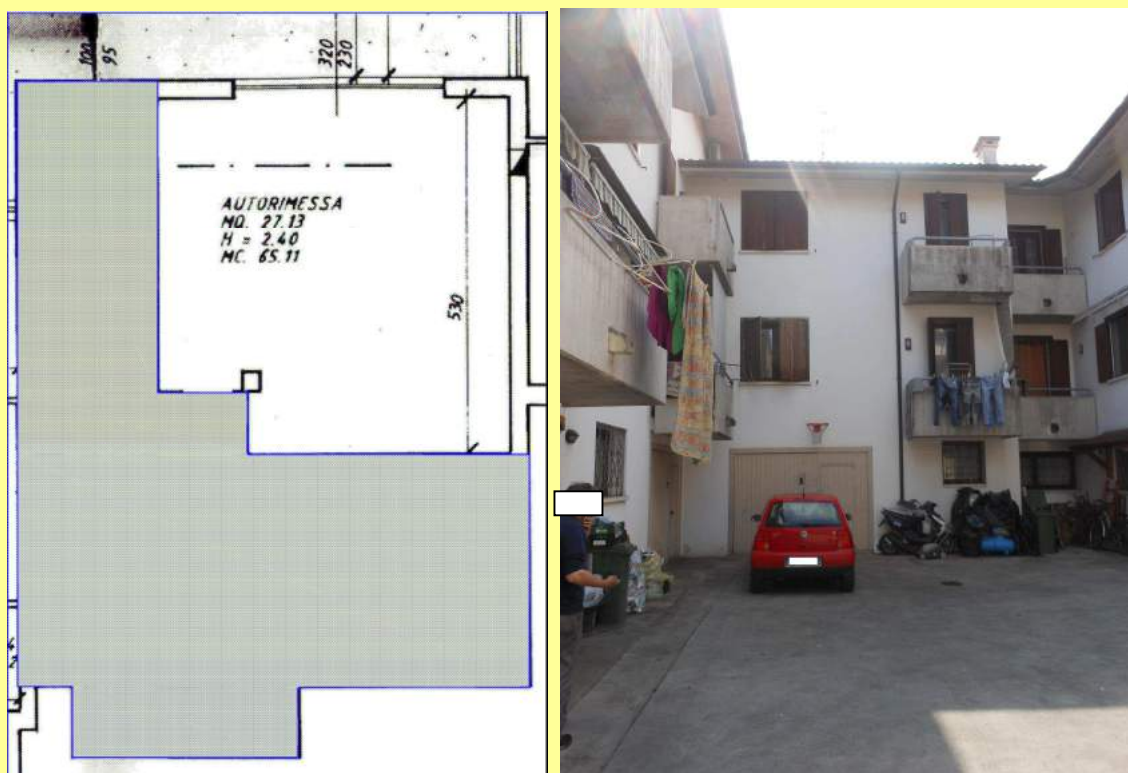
Planimetria dello stato di fatto dell'autorimessa e immagine dall'esterno.
